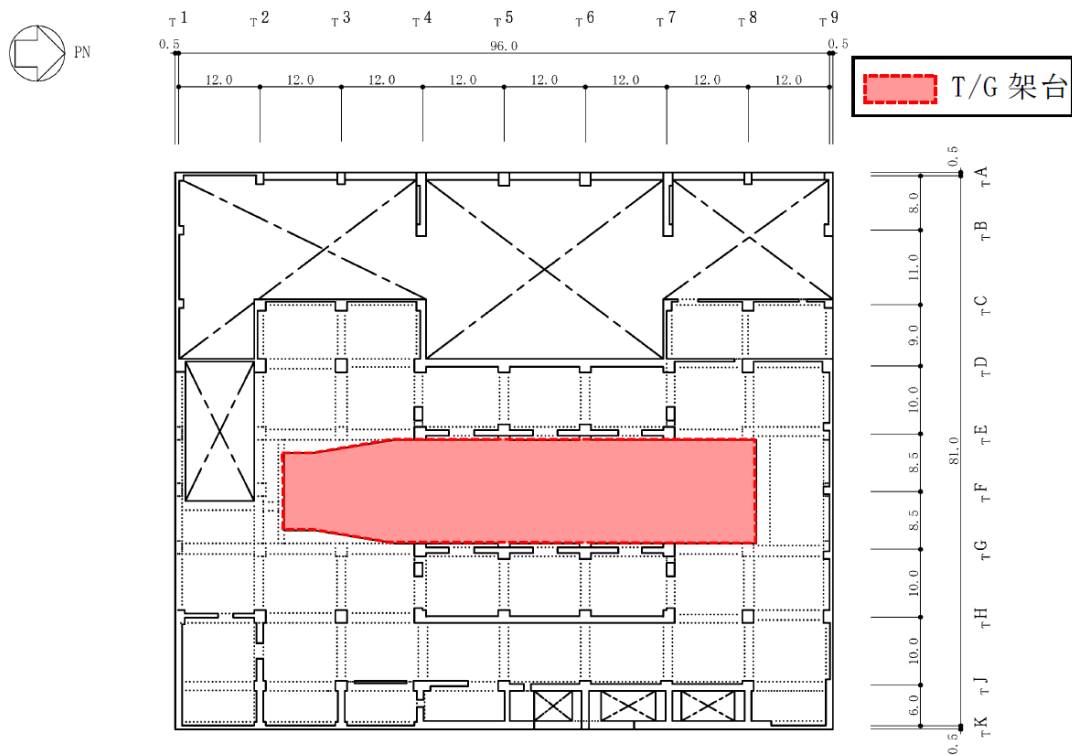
タービン建屋の概略平面図（2F，T. M. S. L. 20.4m）（2/2）（単位：m）
